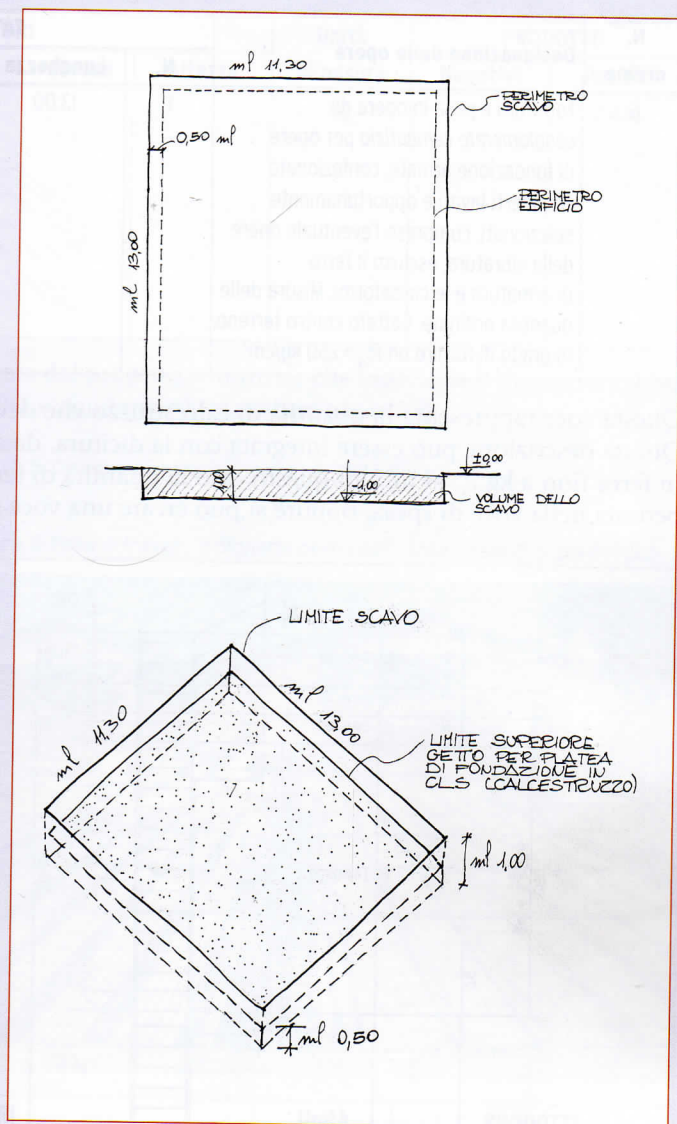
Pianta, sezione ed assonometria dello scavo di fondazione e del volume del getto in CLS.
